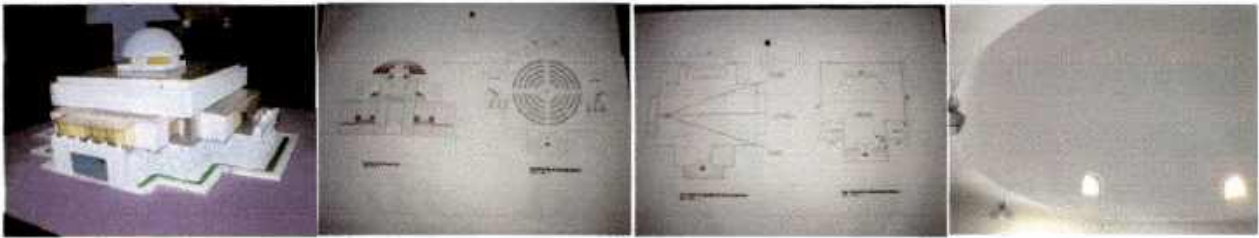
Observatorio astronómico que consta de tres plantas, planta baja: Planetario, primer piso: observatorio andino, segundo piso: observatorio astronómico. Fig. 2: Planos: Vista de frente, planta baja, primer piso y segundo piso. Fig. 3: ejemplo de la forma de la cúpula del observatorio astronómico (piso 2). Fuente: elaboración propia
